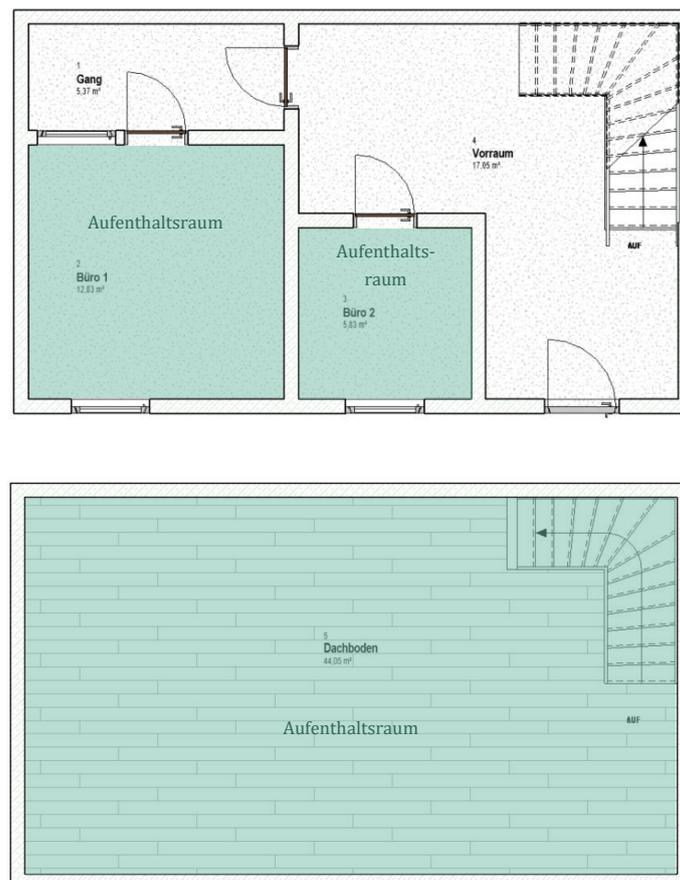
Grundriss EG (oben) und OG 1 (unten) BIM-Modell OIB RL 3 – 11.2.1/11.2.2
